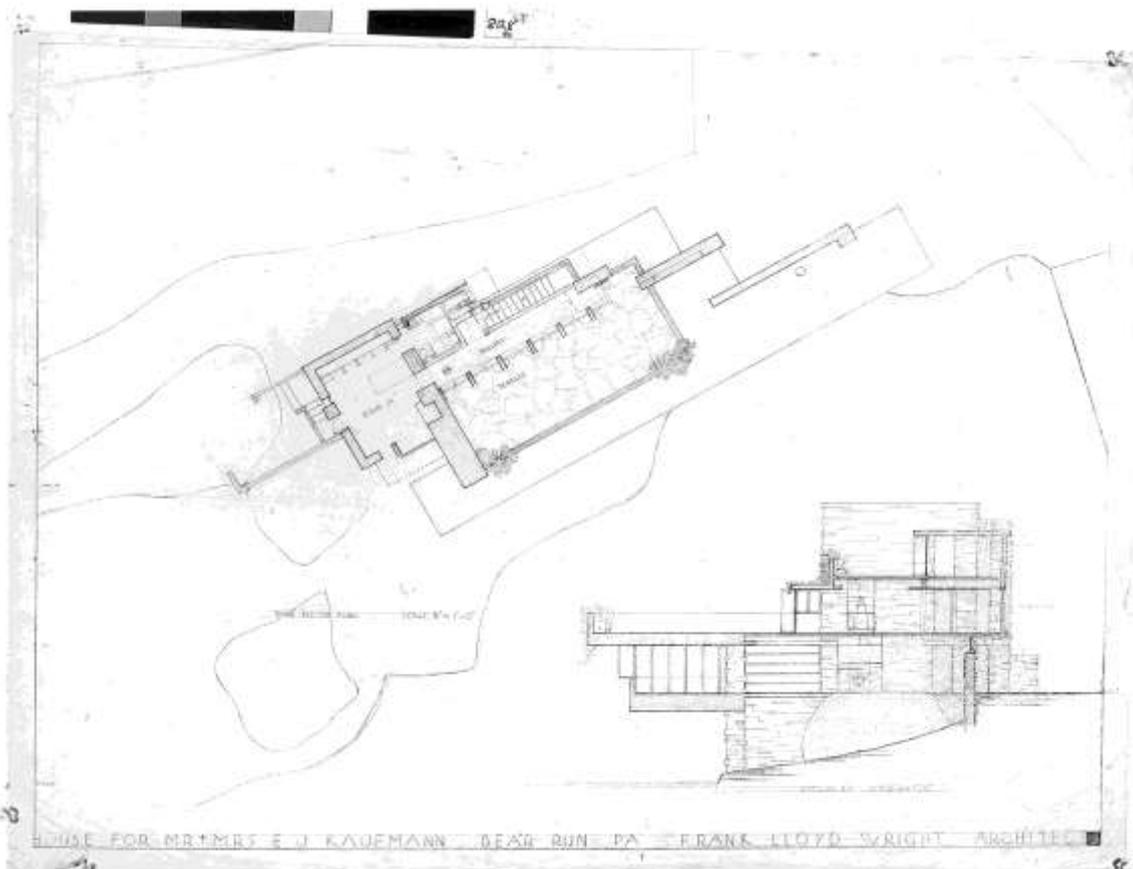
« Third floor plan scale 1"=1'-0" / section A-A scale 1"=1'-0" », coupe sud-nord Columbia FLLW 3602 p.36
